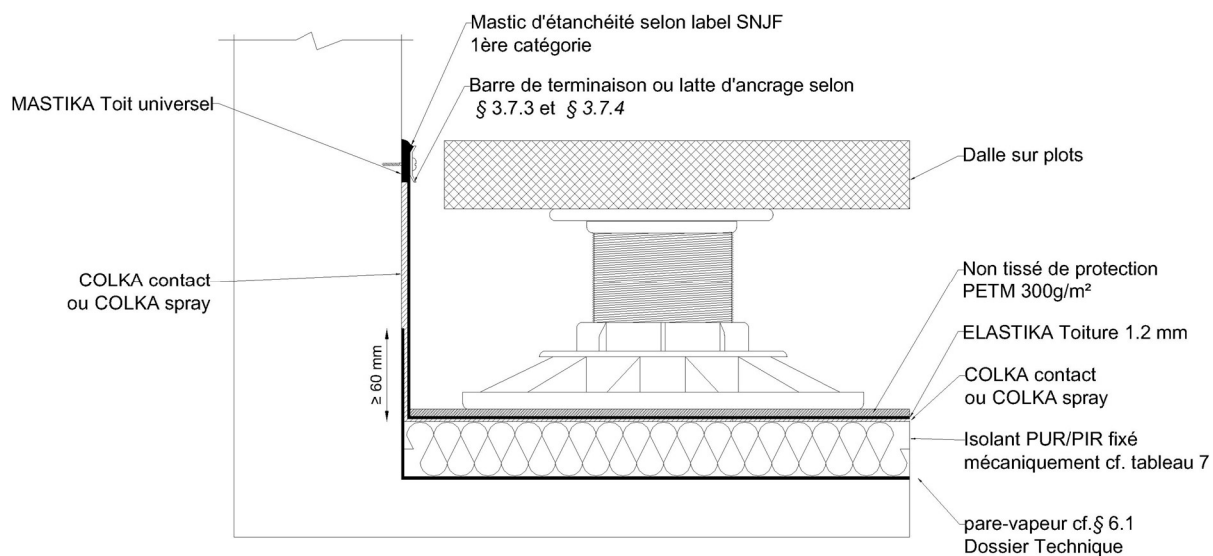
Toiture terrasse accessible aux piétons et séjour avec protection par dalles sur plots
